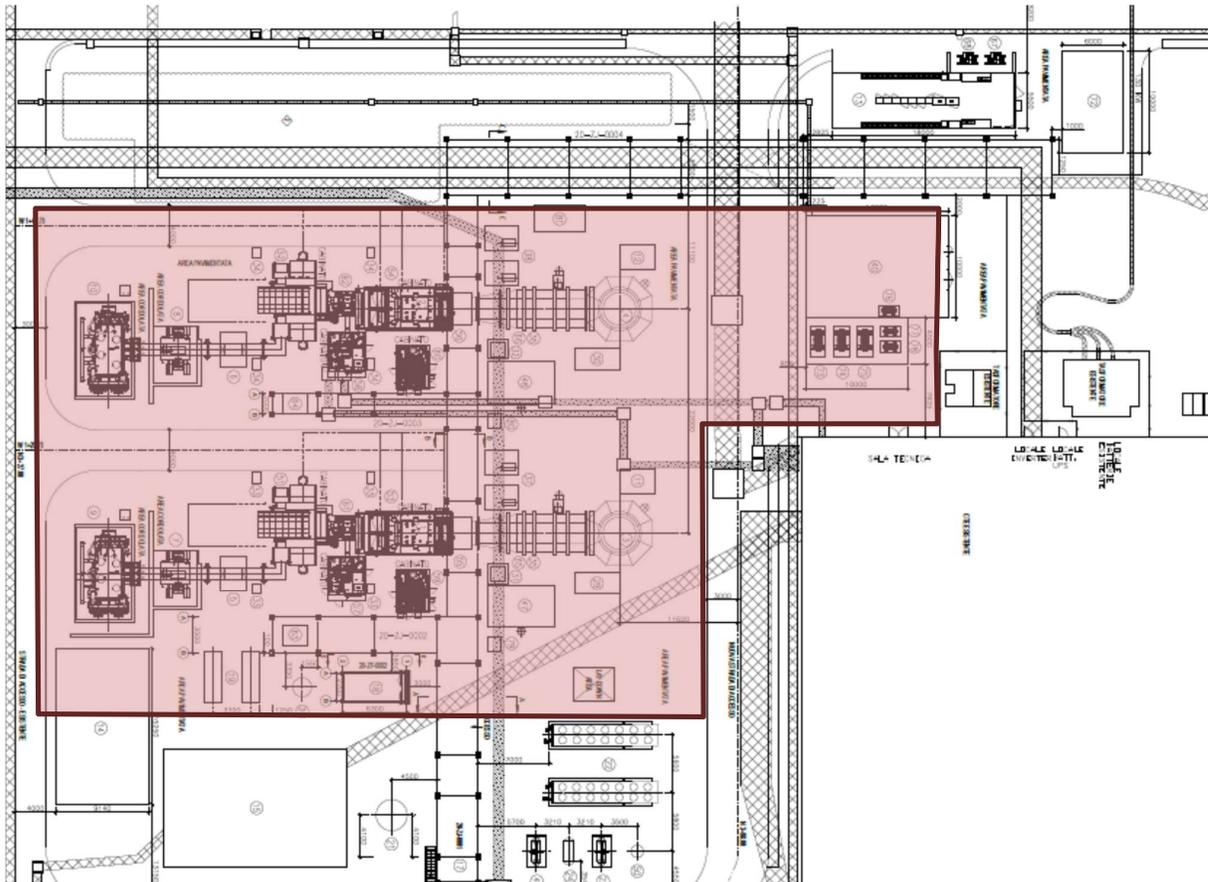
Planimetria delle Aree indicative di scavo (estratto da 017101BTDP62000\_CDFE01\_1 - PLANT GENERAL PLOT PLAN)
